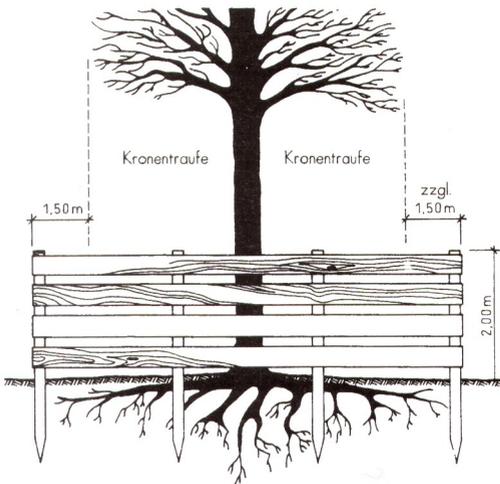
Normgerechter Schutzzaun für einen zu erhaltenden Baum auf Baustellen.
